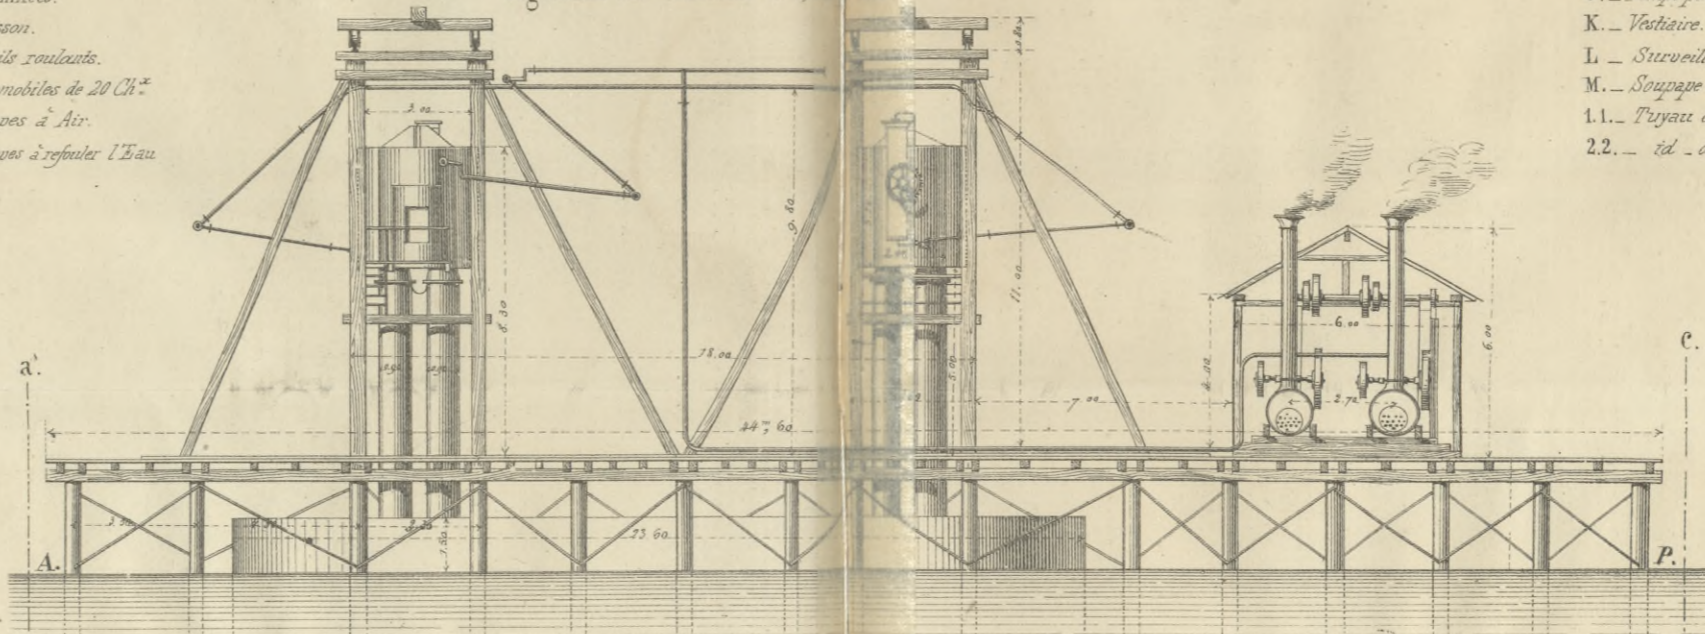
Vue de face a.b. à 0^e005 pour 1^e00.
